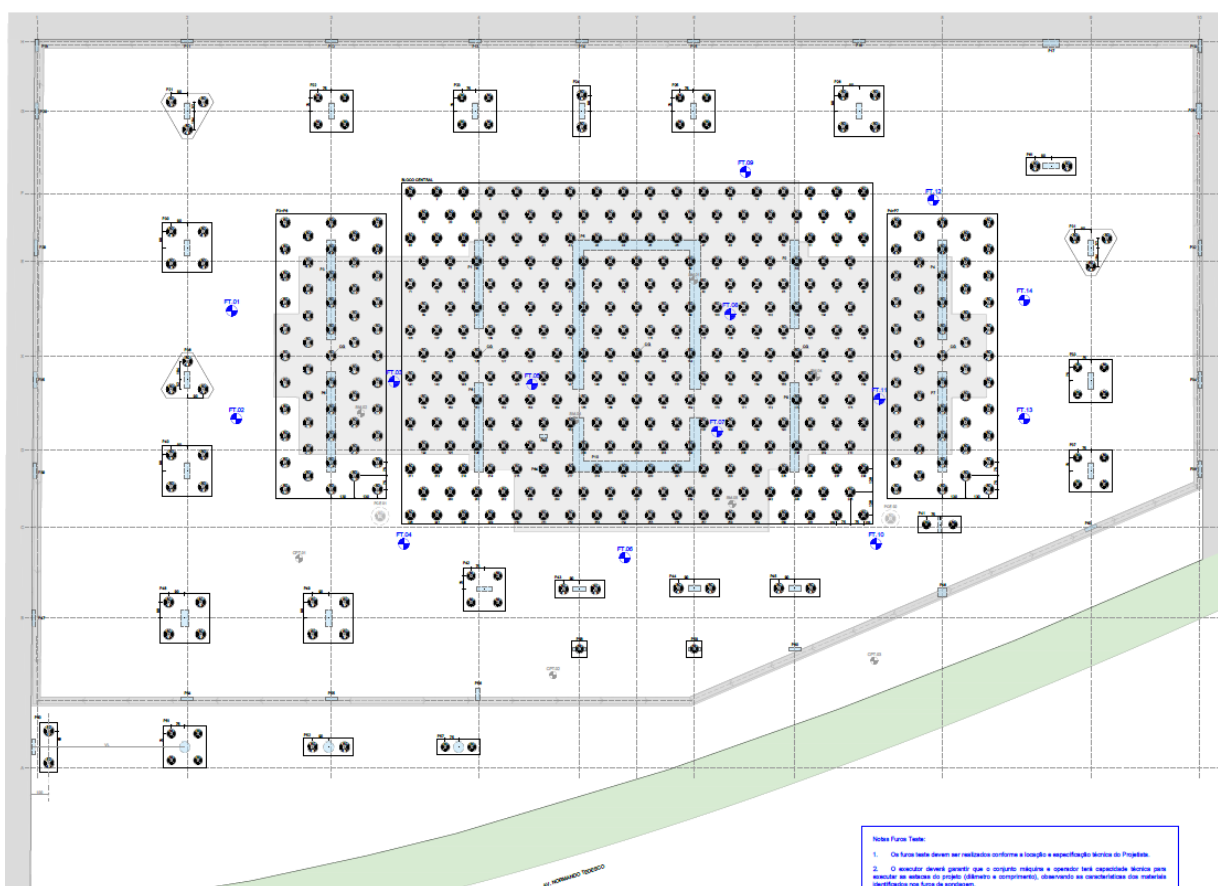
Desenho em planta do projeto geotécnico de fundações (BornSales, 2023c).
